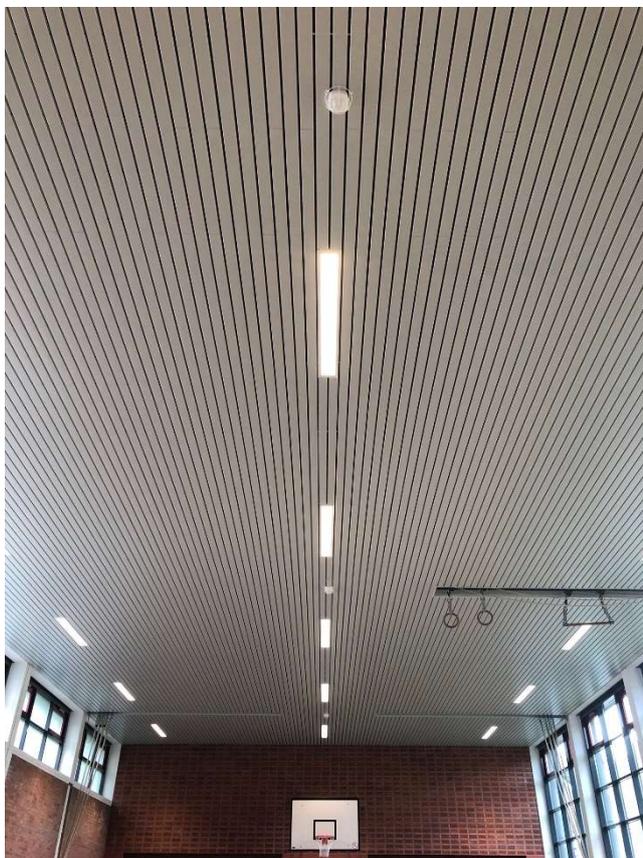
Deckenstrahlheizung Turnhalle TKS
